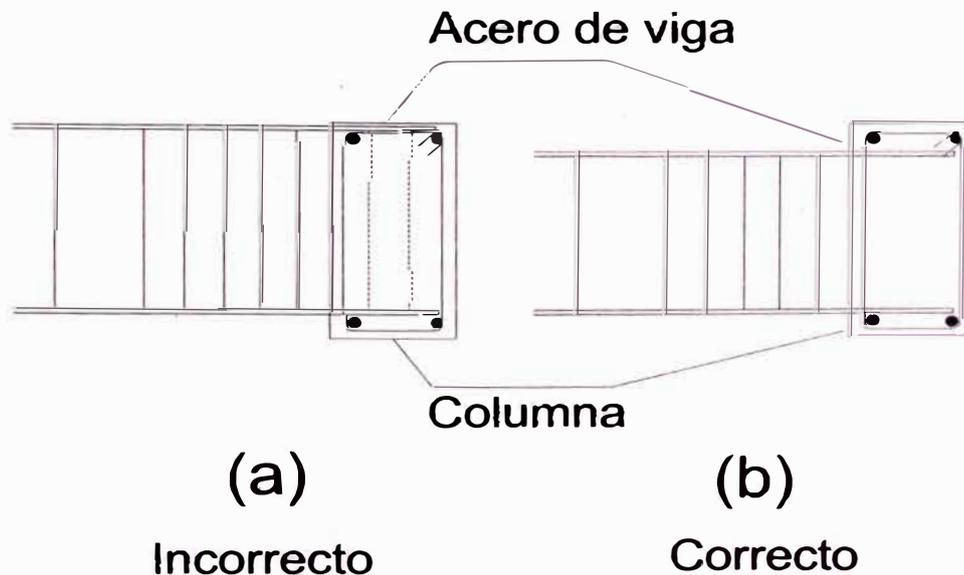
Vista en planta. Mala colocación del refuerzo de viga en encuentro (a) con columna y el modo correcto en (b). Obsérvese los estribos adicionales dentro de la columna en el primer caso.
